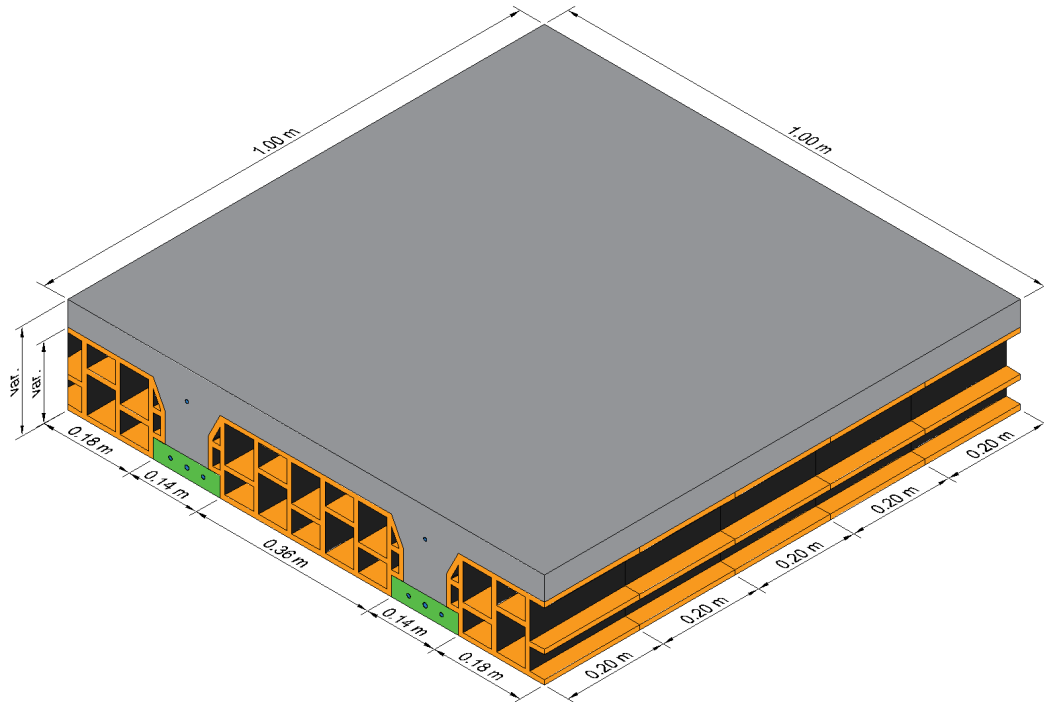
Losa Aligerada Unidireccional del Sistema Prefabricado Alitec.
